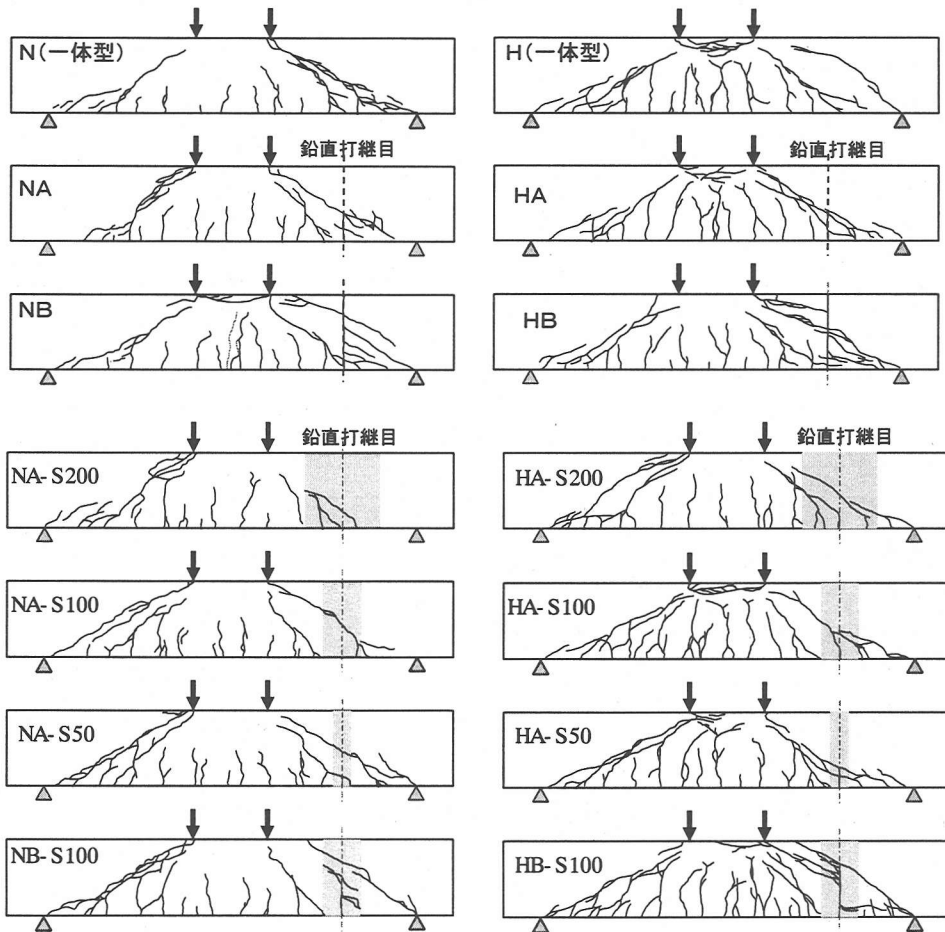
小型RCはりのひび割れ発生状況（破線は打継目位置，網掛けは鋼板被覆）
